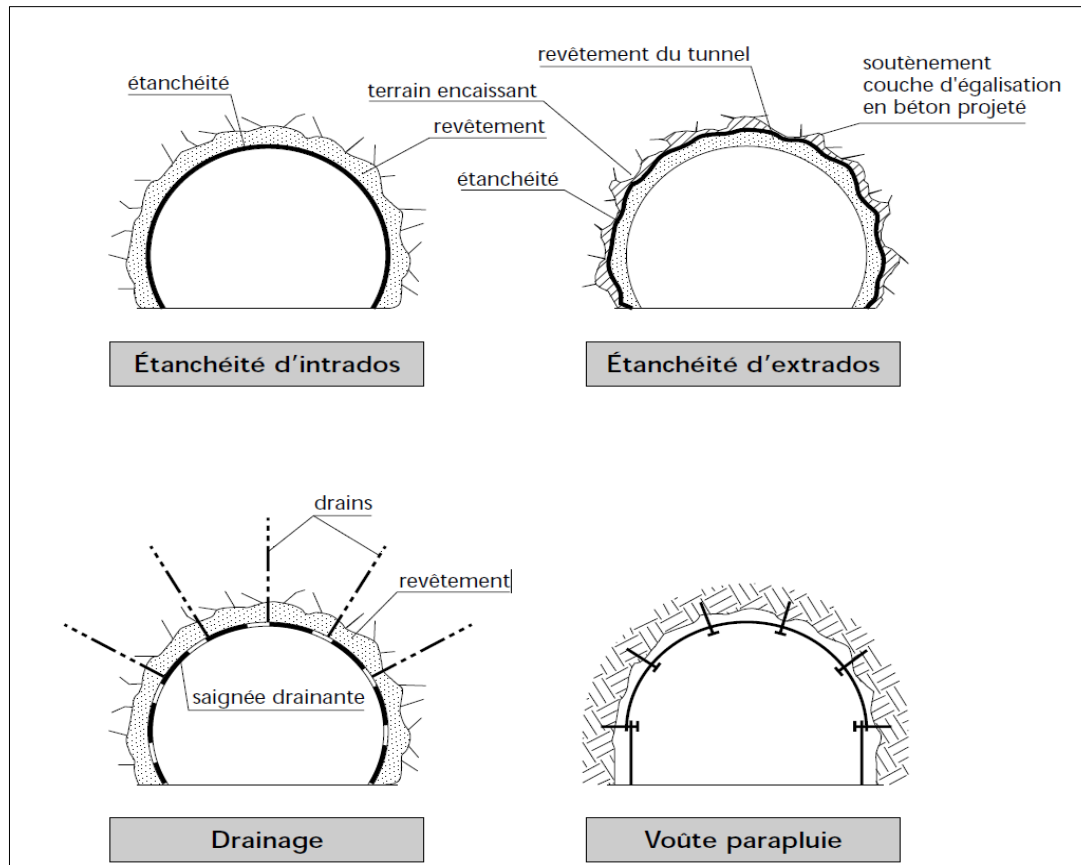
Principaux types d'étanchement des tunnels (CETU5, 1998).
